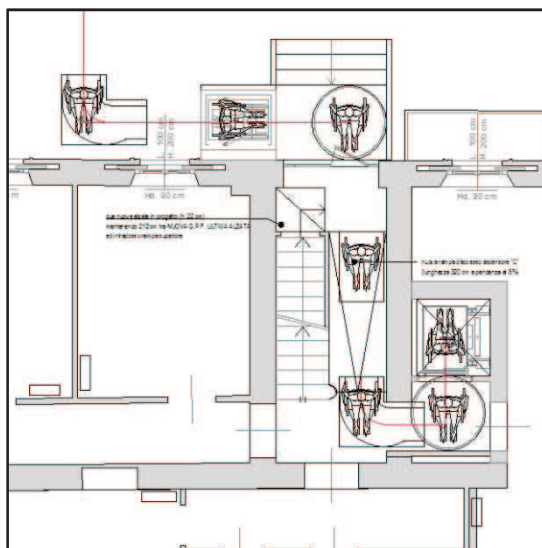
PARTICOLARE PIANTA ACCESSIBILITA' piattaforma elevatrice per accesso alla scala C
